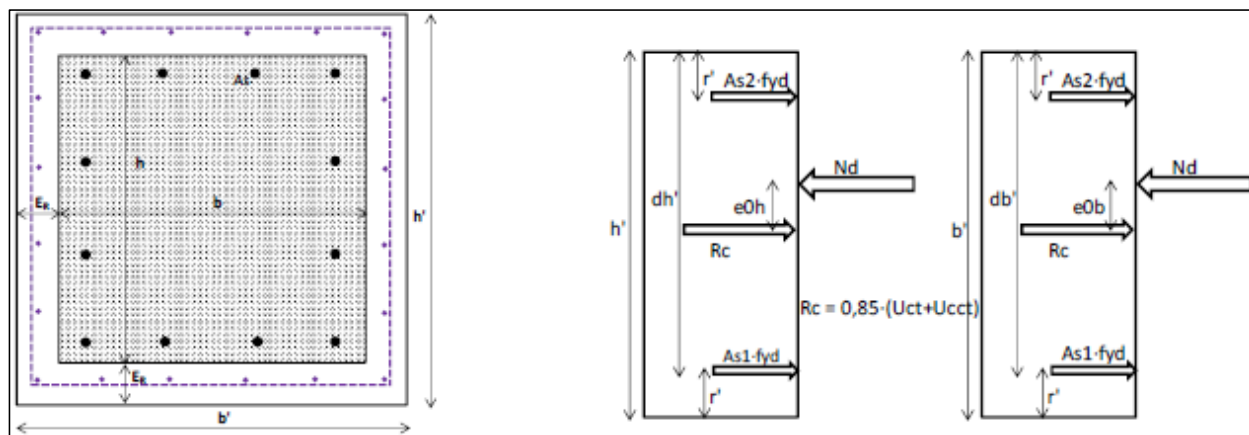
Sección de refuerzo de una columna rectangular con concreto reforzado.
